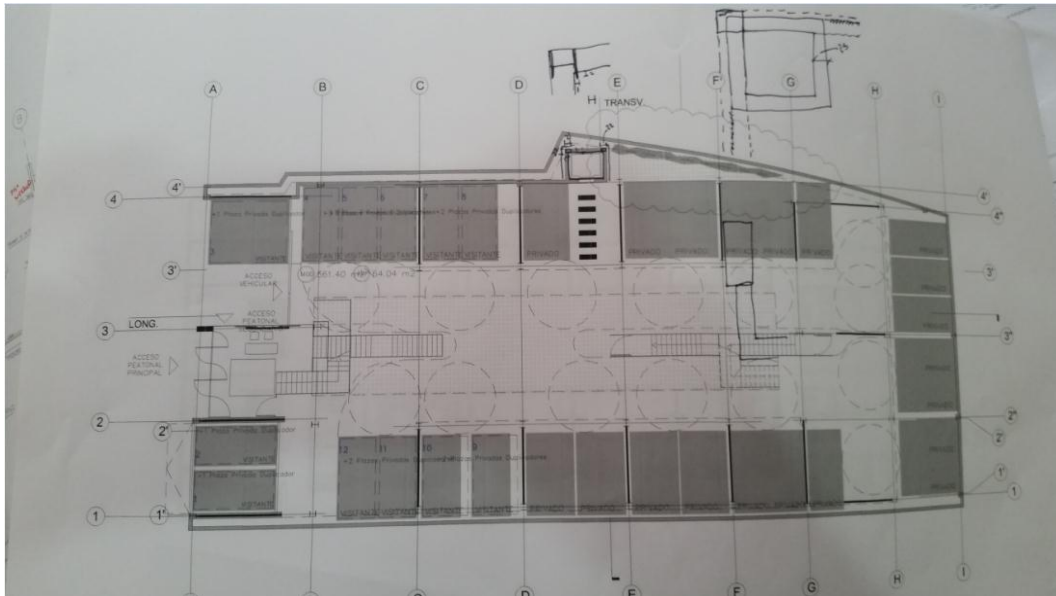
PLANO ARQUITECTÓNICO DEFINITIVO – SÓTANO IMPRESO.
